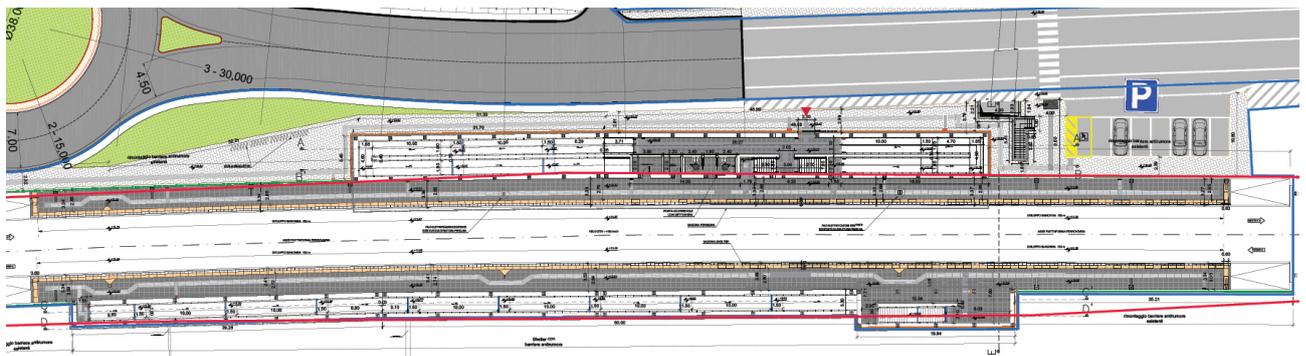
Sezione con focus su Rampe accesso banchina MA1 e sottopasso
